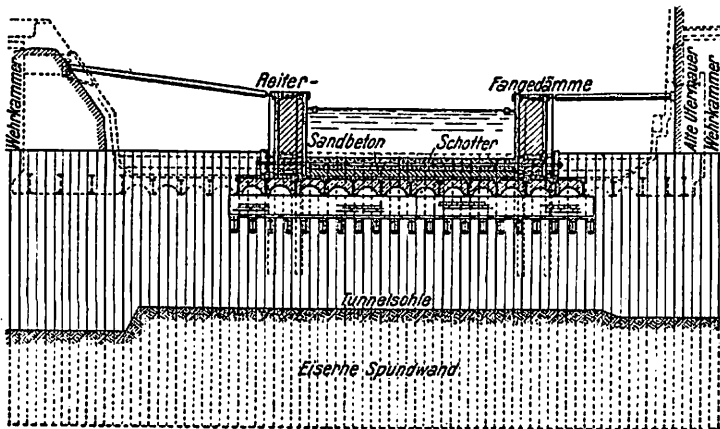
Längsschnitt der Landwehrkanal-Unterfahung im Bauabschnitt III.
